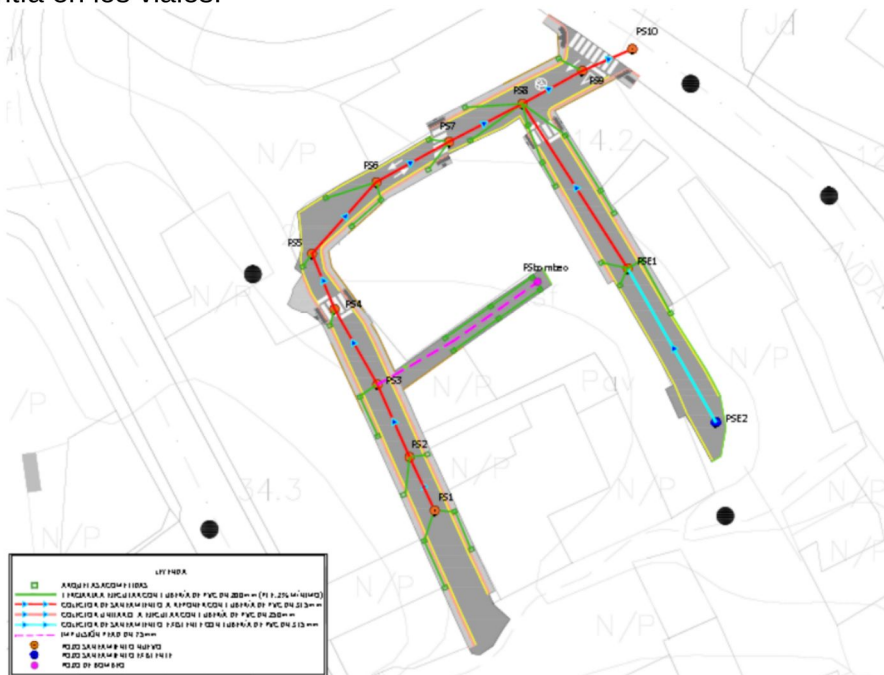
Extracto de plano nº6 Red de saneamiento planta
